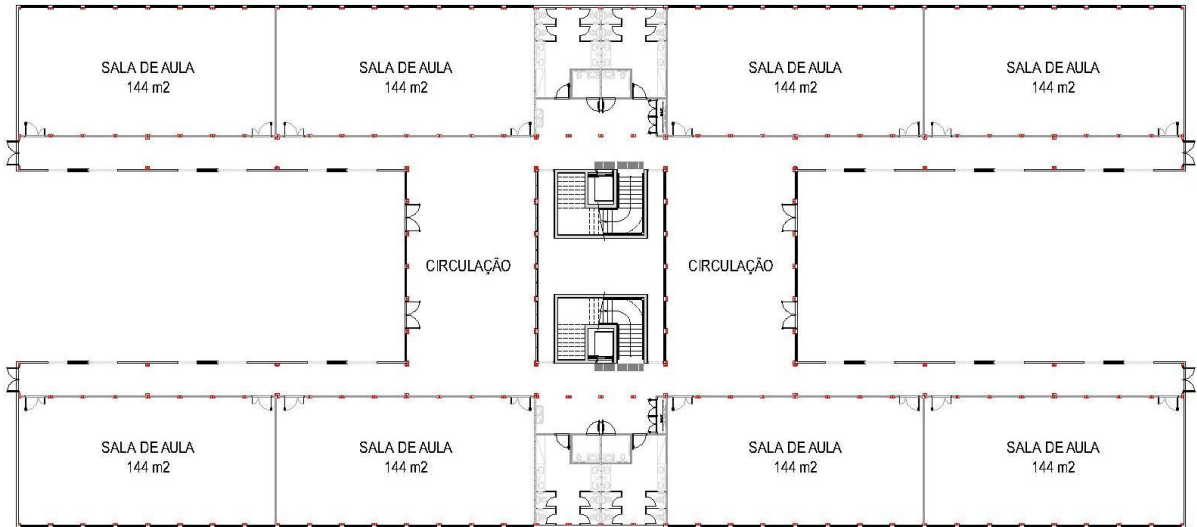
Planta com a disposição dos módulos estruturais atendendo demanda maior que o AT7
